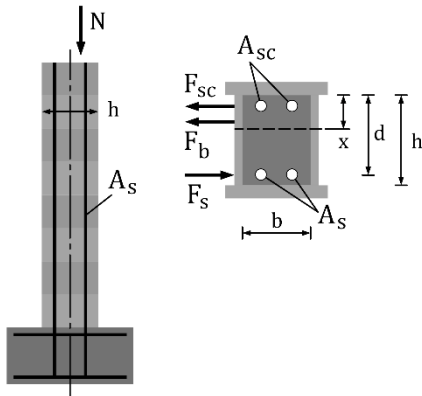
Конструктивна схема стінки з бетонних блоків (ліворуч) та розрахунковий залізобетонний переріз (праворуч)
